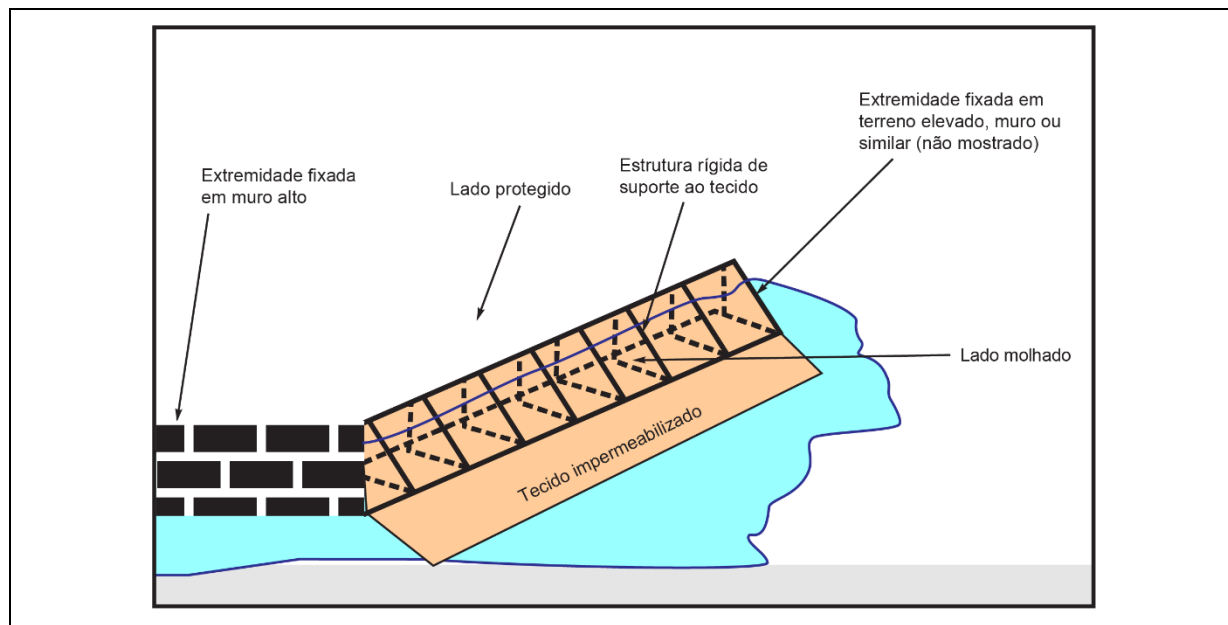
Ensacadeiras de tecido impermeável com estrutura rígida
